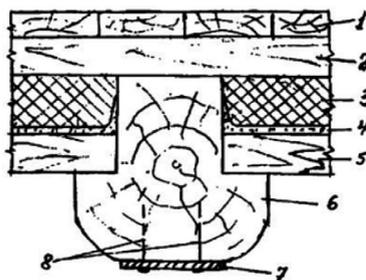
Схема усиления балки перекрытия присоединением стального листа снизу:
